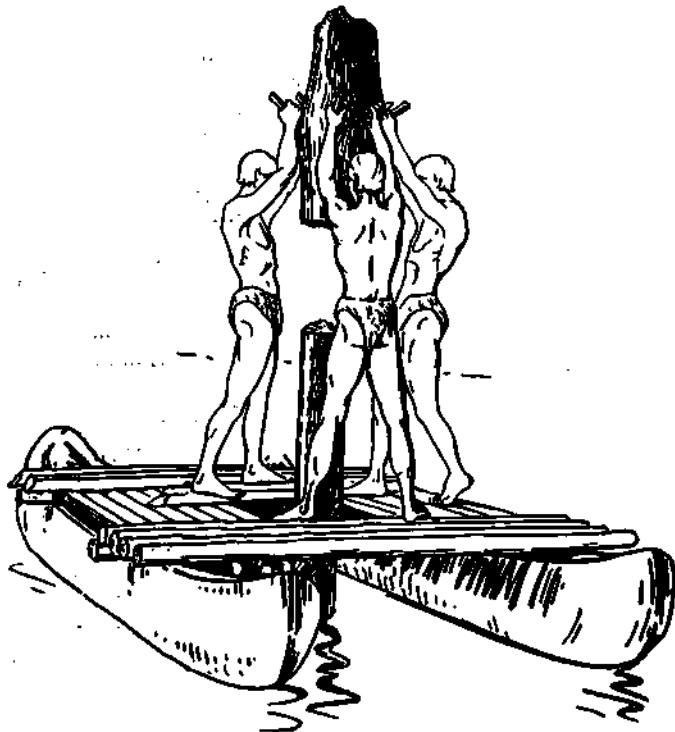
Забивание свай в дно озера на палафитах (реконструкция).
